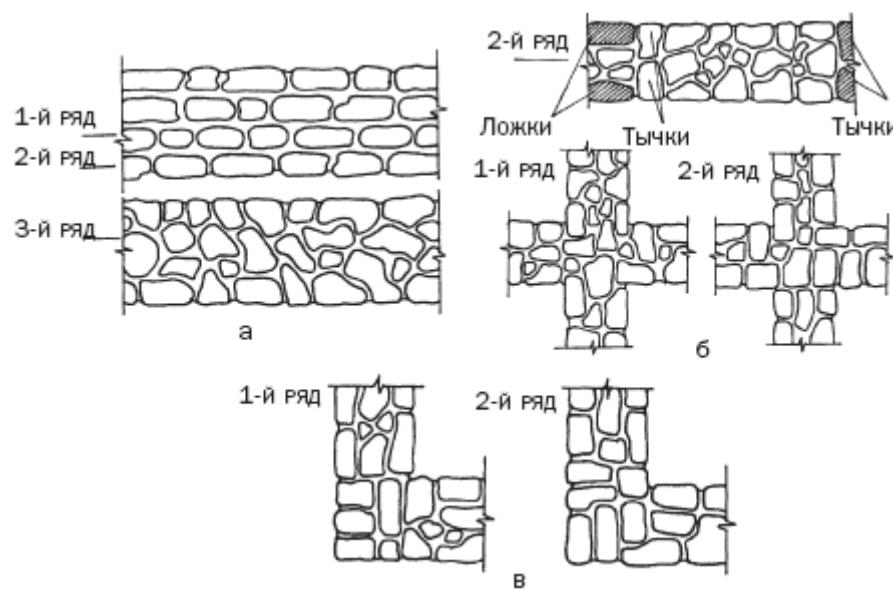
Перевязка бутовой кладки: а – стены; б – пересечения стен; в – углы
